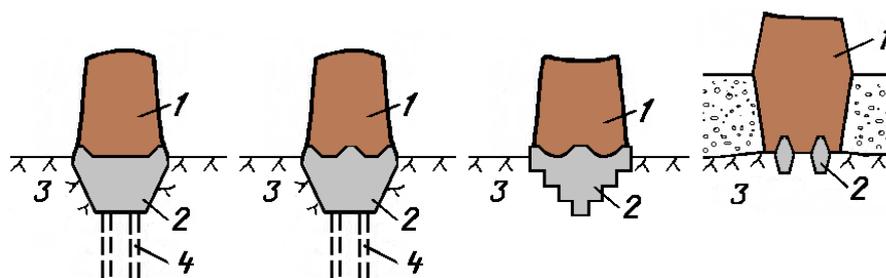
Сопряжение ядра со скальным основанием: 1 – пластичное ядро; 2 – бетонный зуб; 3 – скальное основание; 4 – скважины цементации
